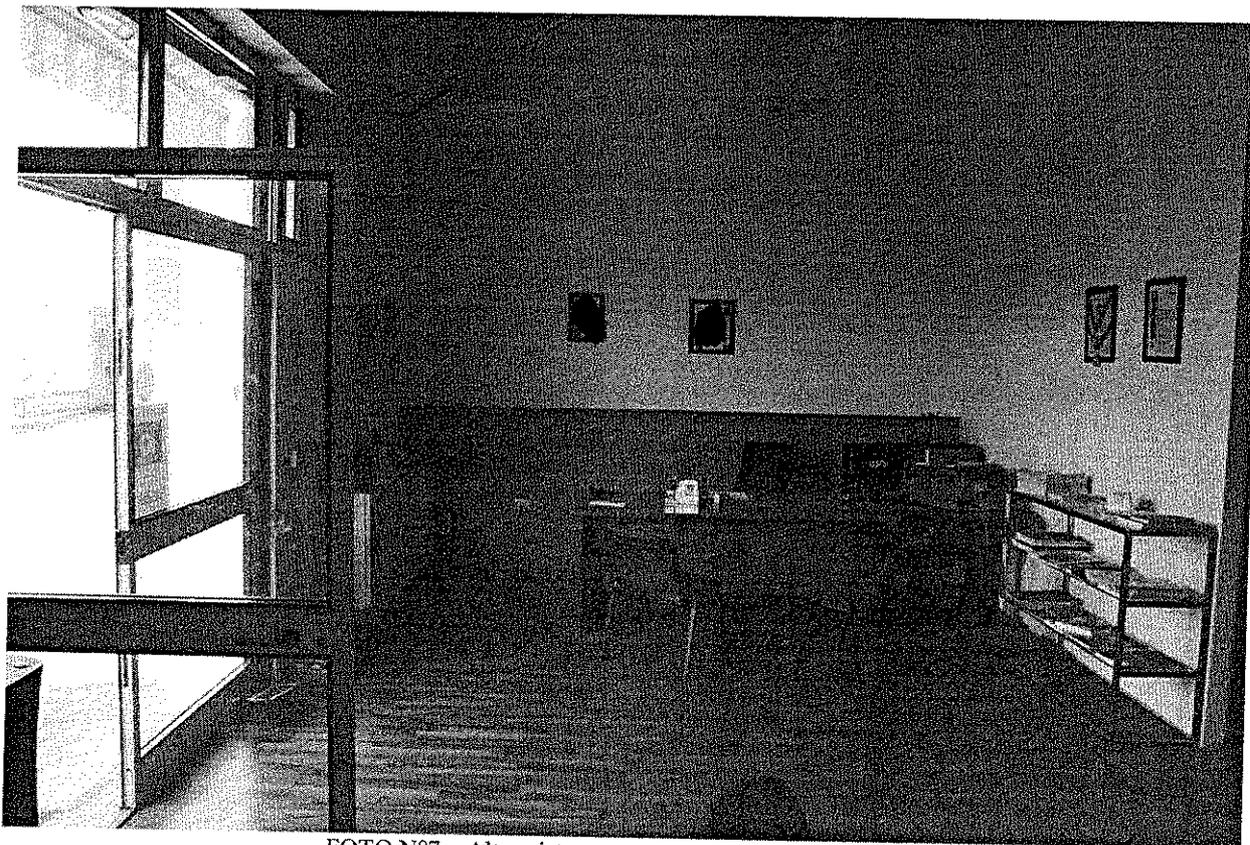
Altra vista *open-space* presente all'ingresso
